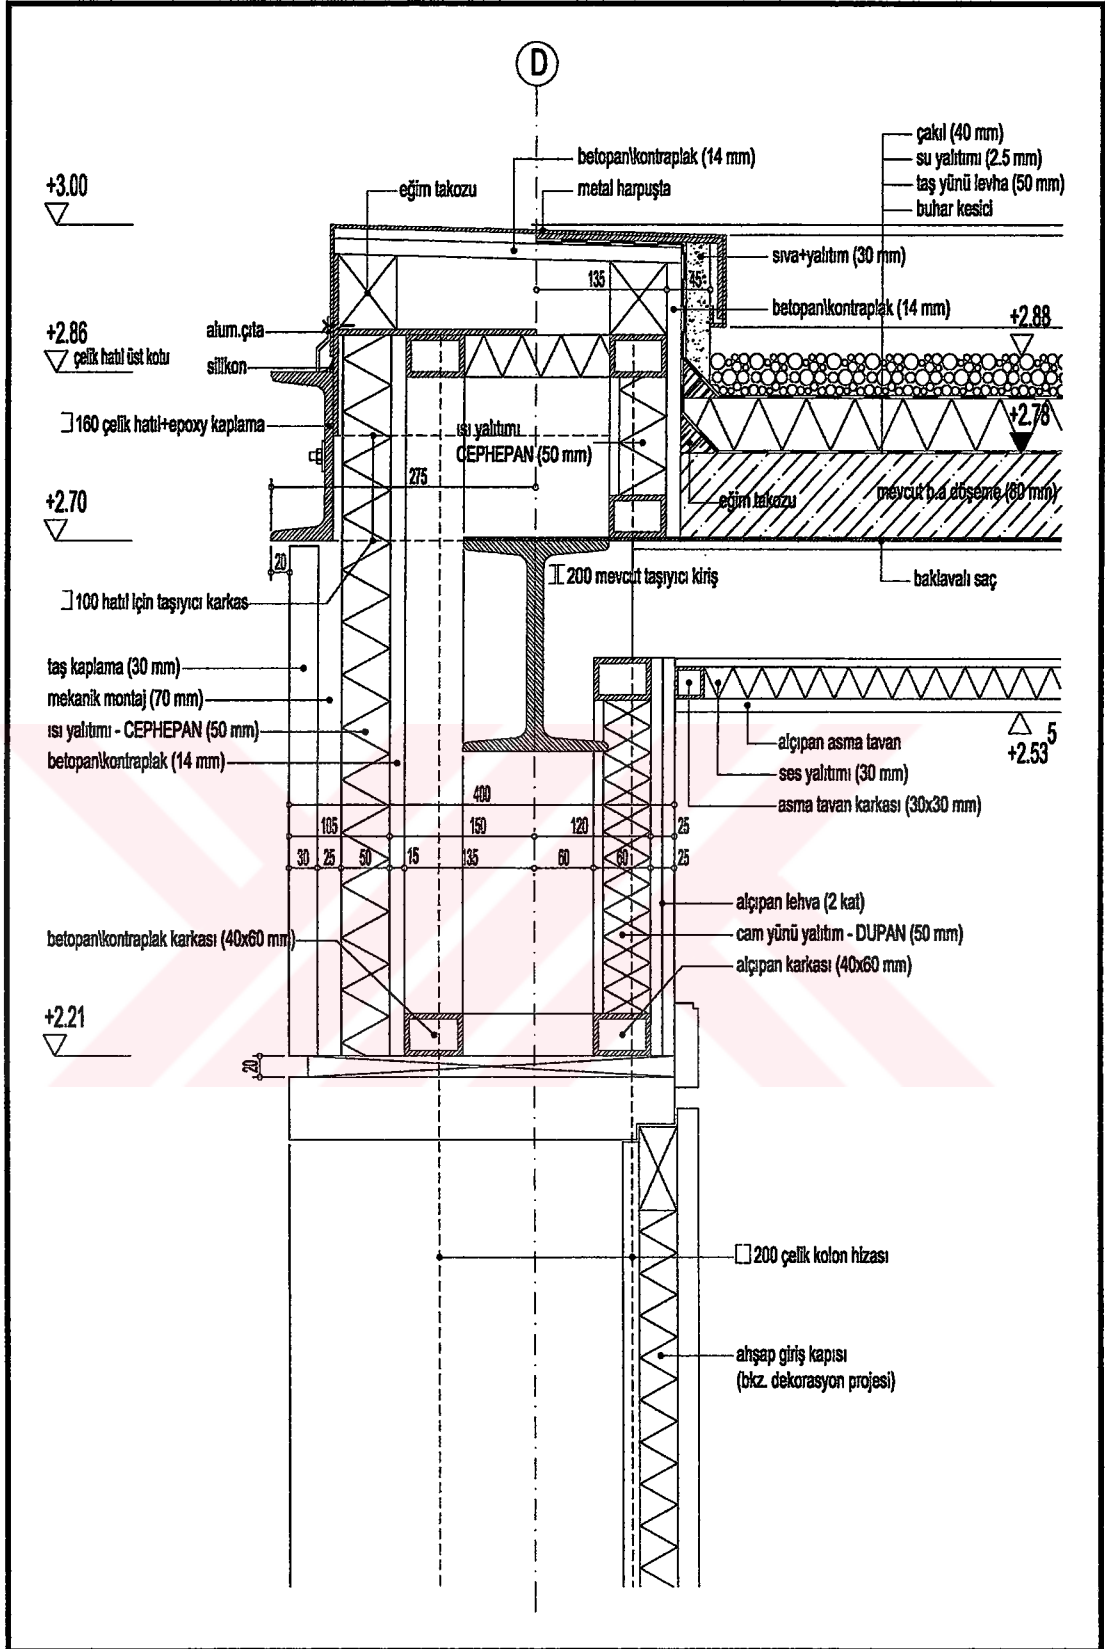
Giriş sistem detayı kesiti ve nokta detaylarının yerleri
